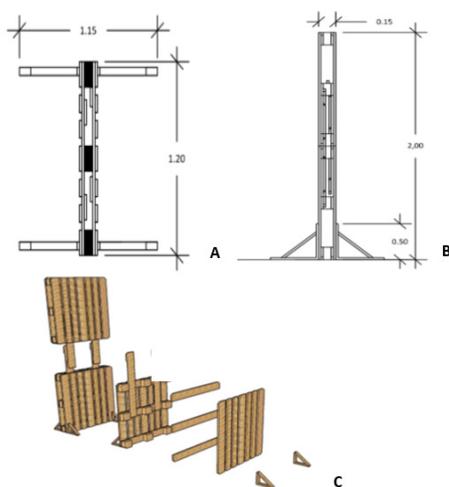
Projeto técnico do painel de paletes de madeira. (A) Vista em planta. (B) Vista lateral. (C) Projeto explodido
